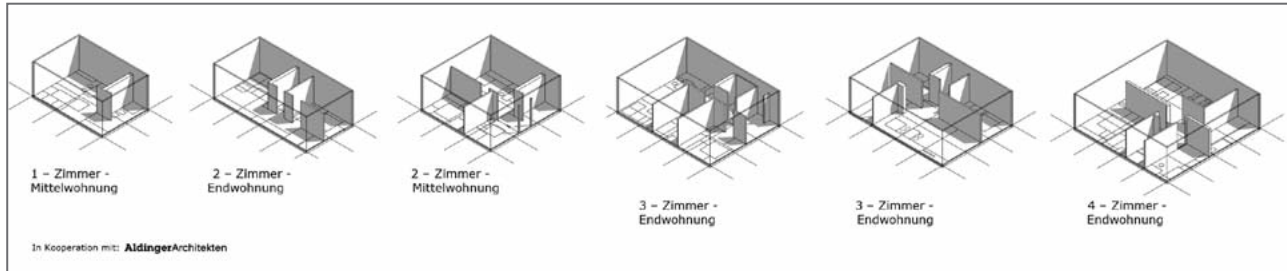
Vordefinierte Grundrisse (Auswahl)
